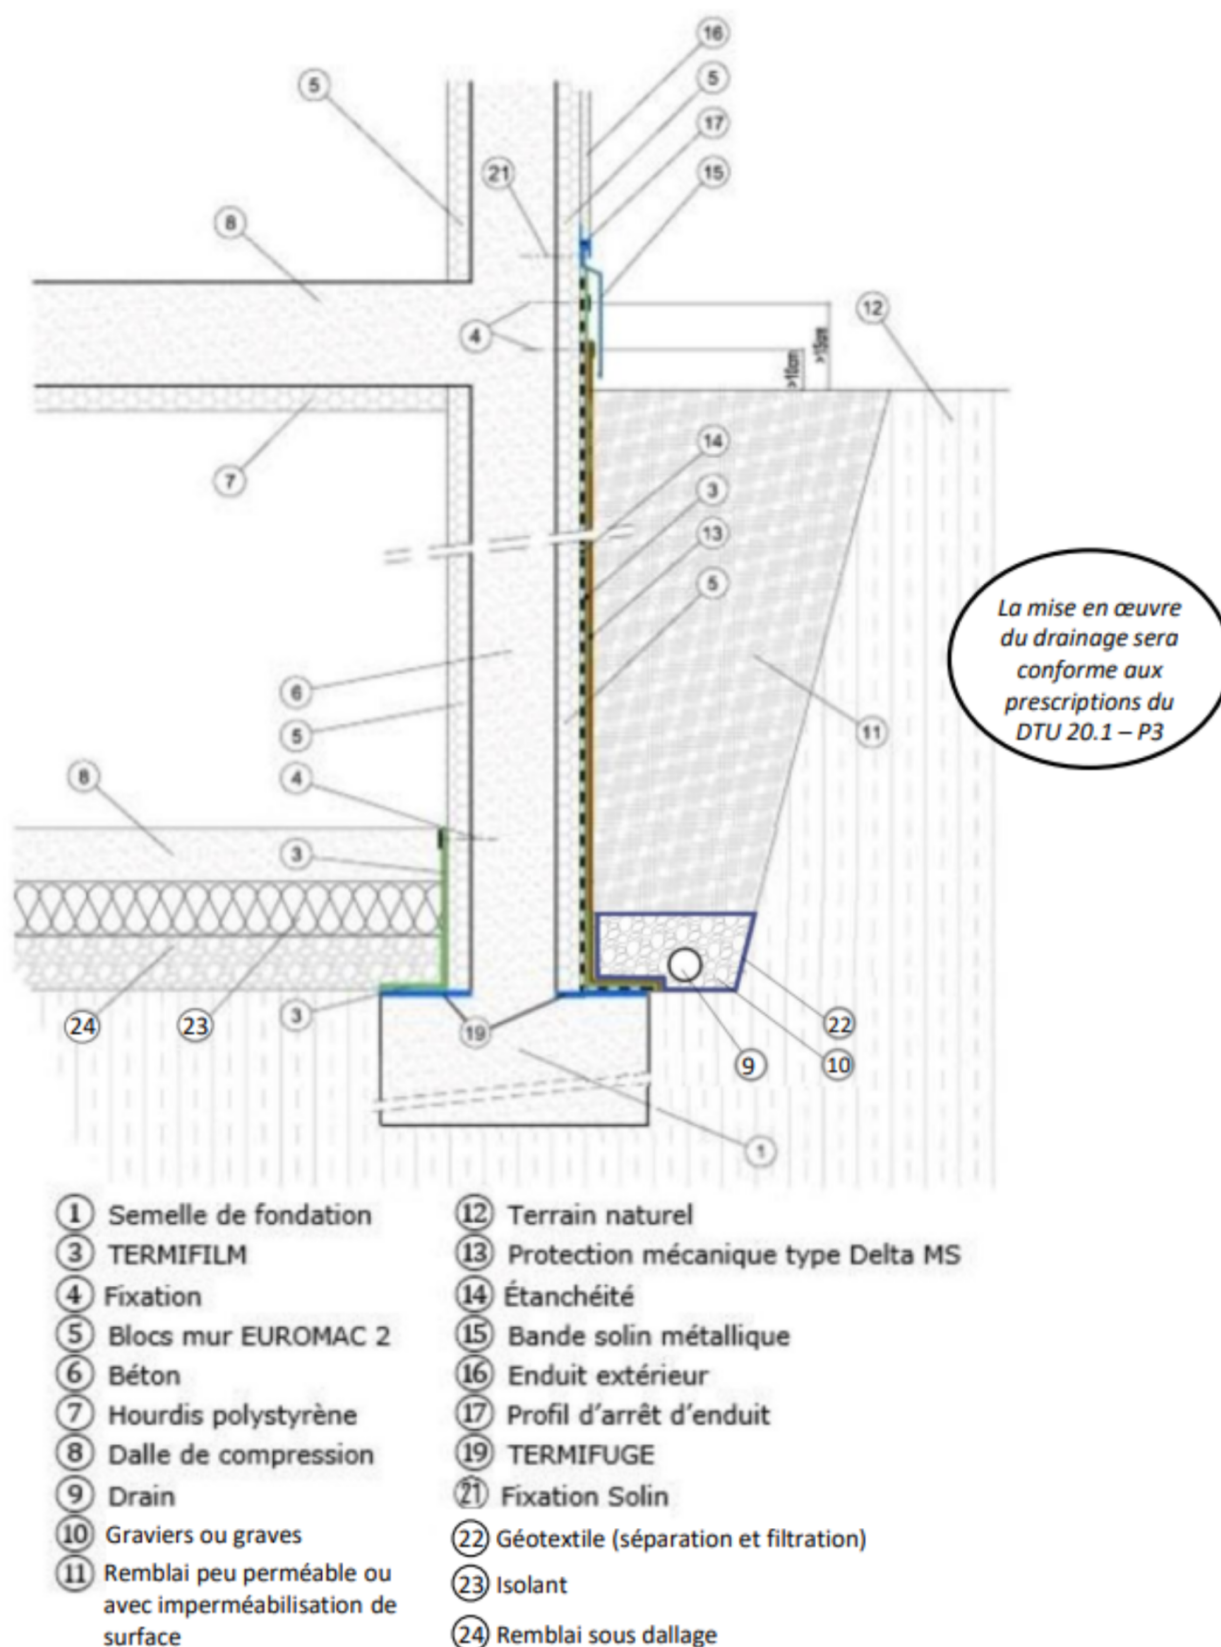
Mur extérieur de sous-sol enterré avec dallage isolé non porteur ; principe avec ou sans isolant en sous face de dalle de plancher
